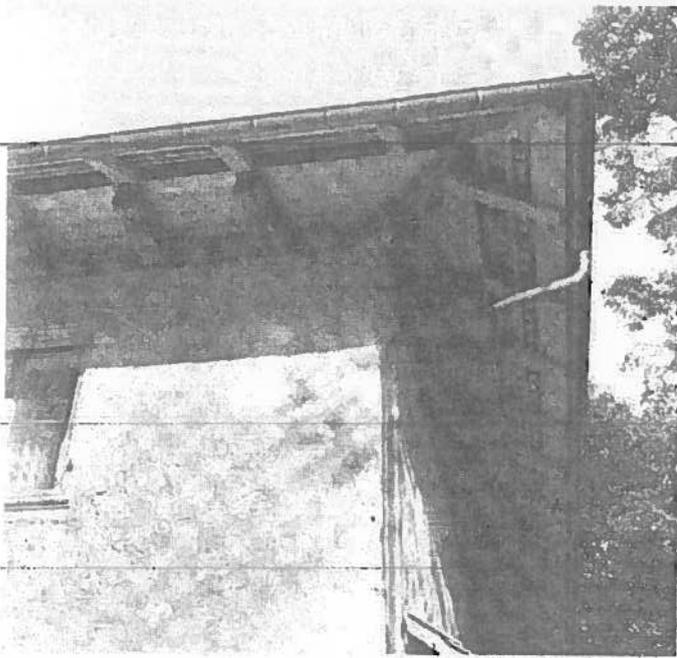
Dachuntersicht des Hauptdaches mit profilierten Stichbalken.
